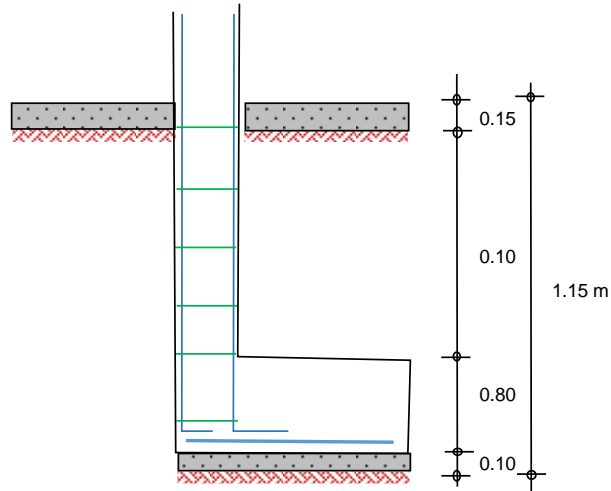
Detalle de sección de zapata excéntrica (Estructura 1).
